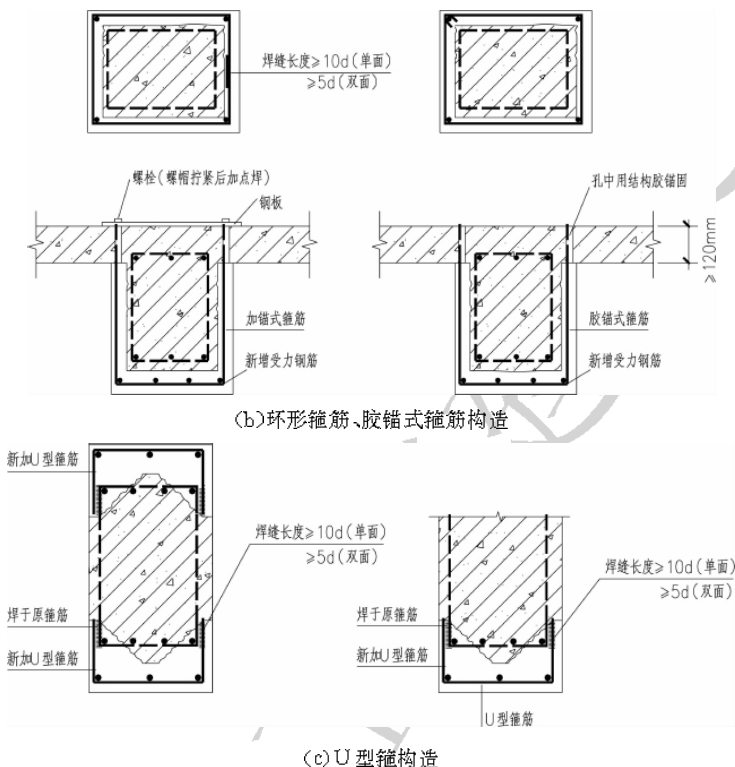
钢筋混凝土配置新增连接箍筋的构造
